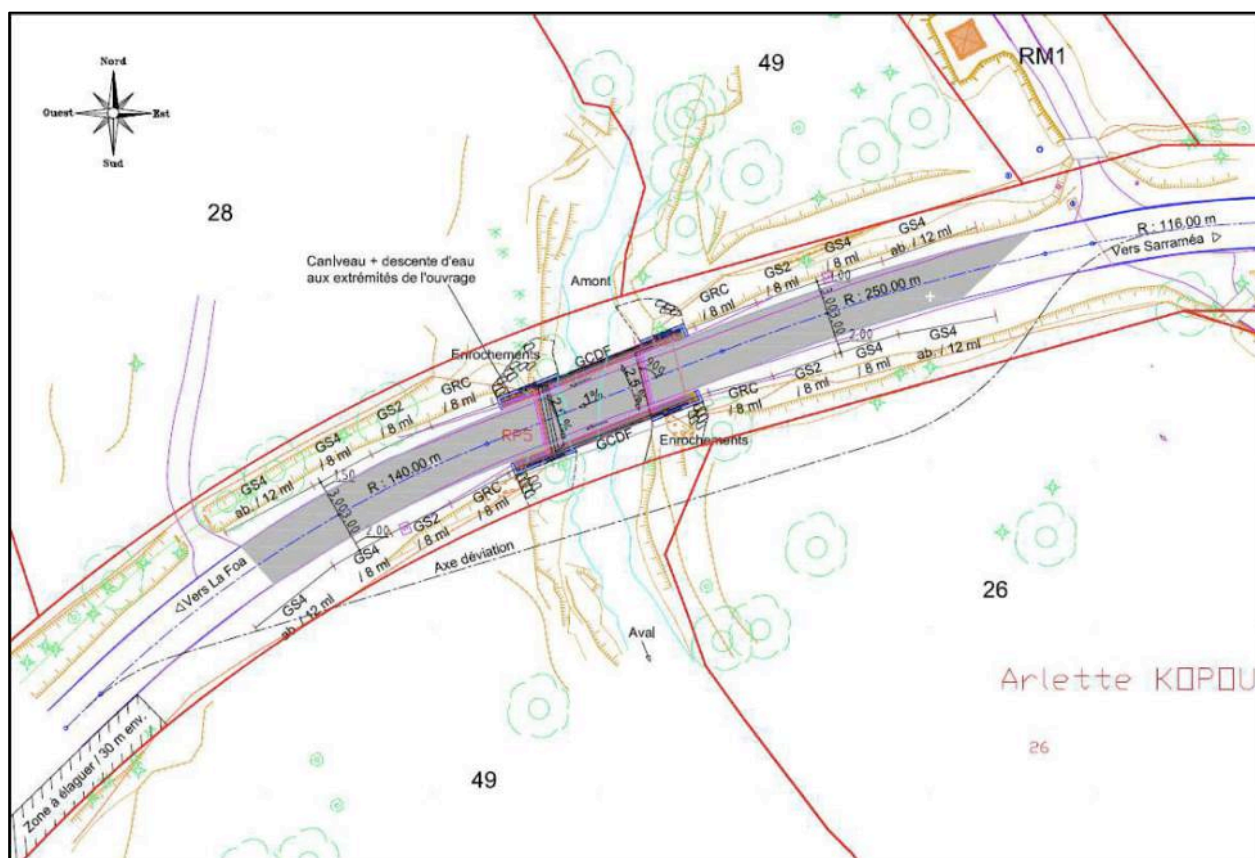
vue de tracé en plan de l'ouvrage prévu (source : DEPS, 2016).
